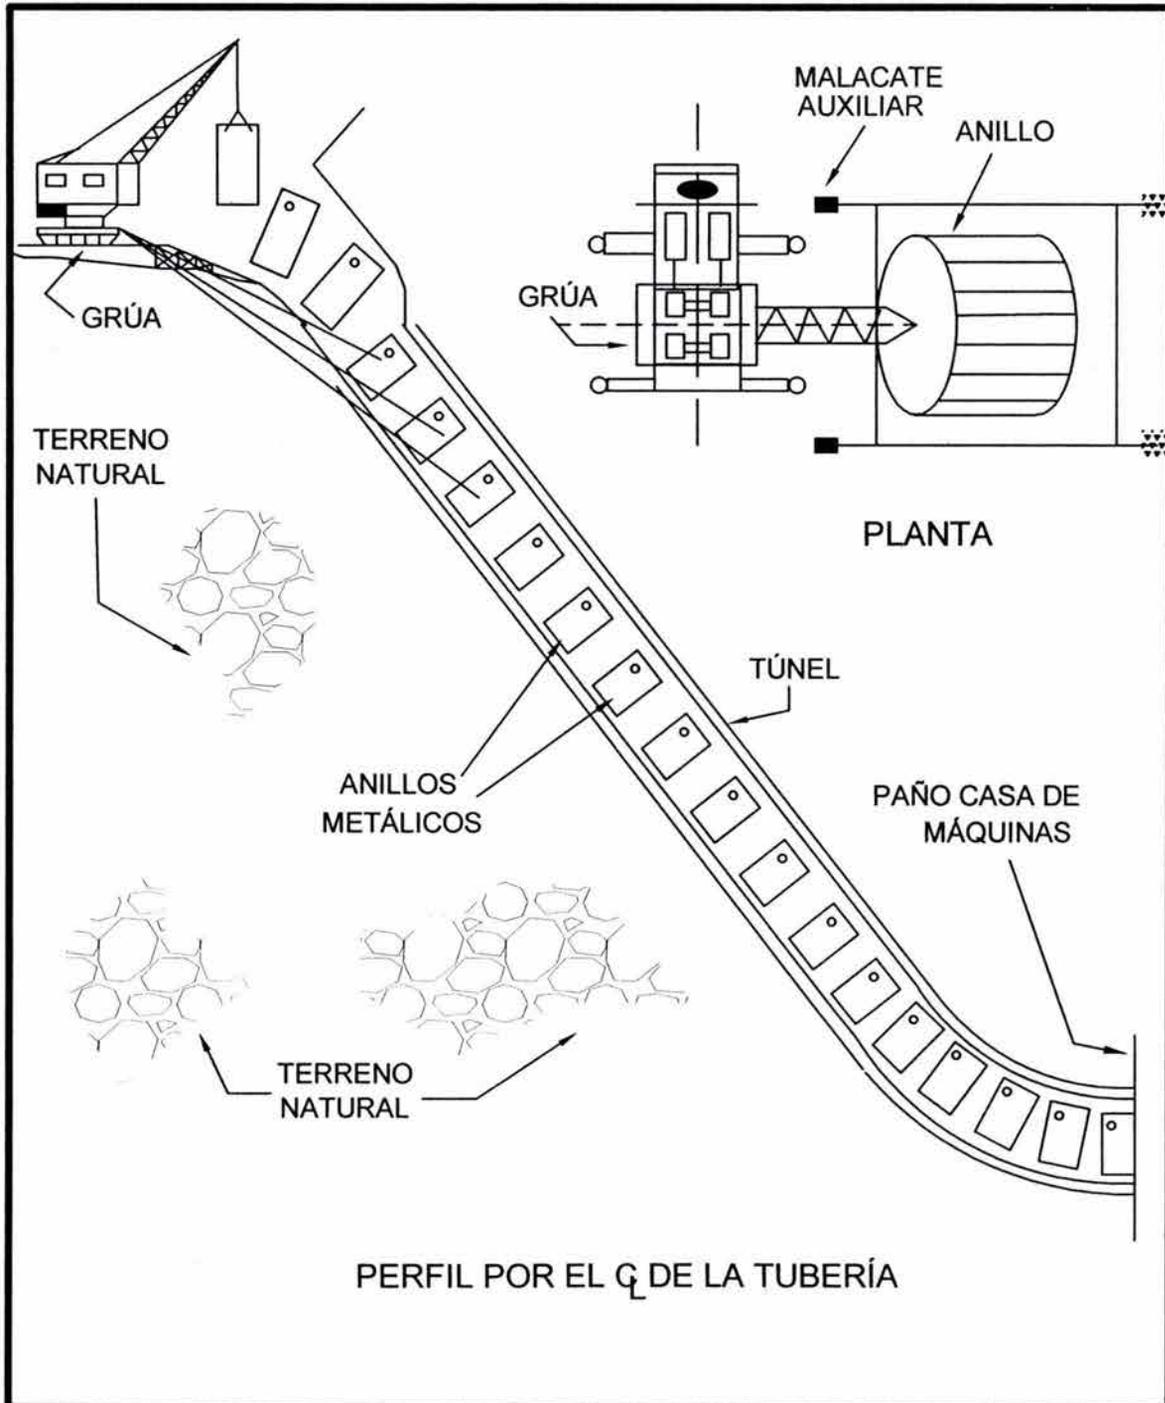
POSICIONAMIENTO DEL BLINDAJE METÁLICO
